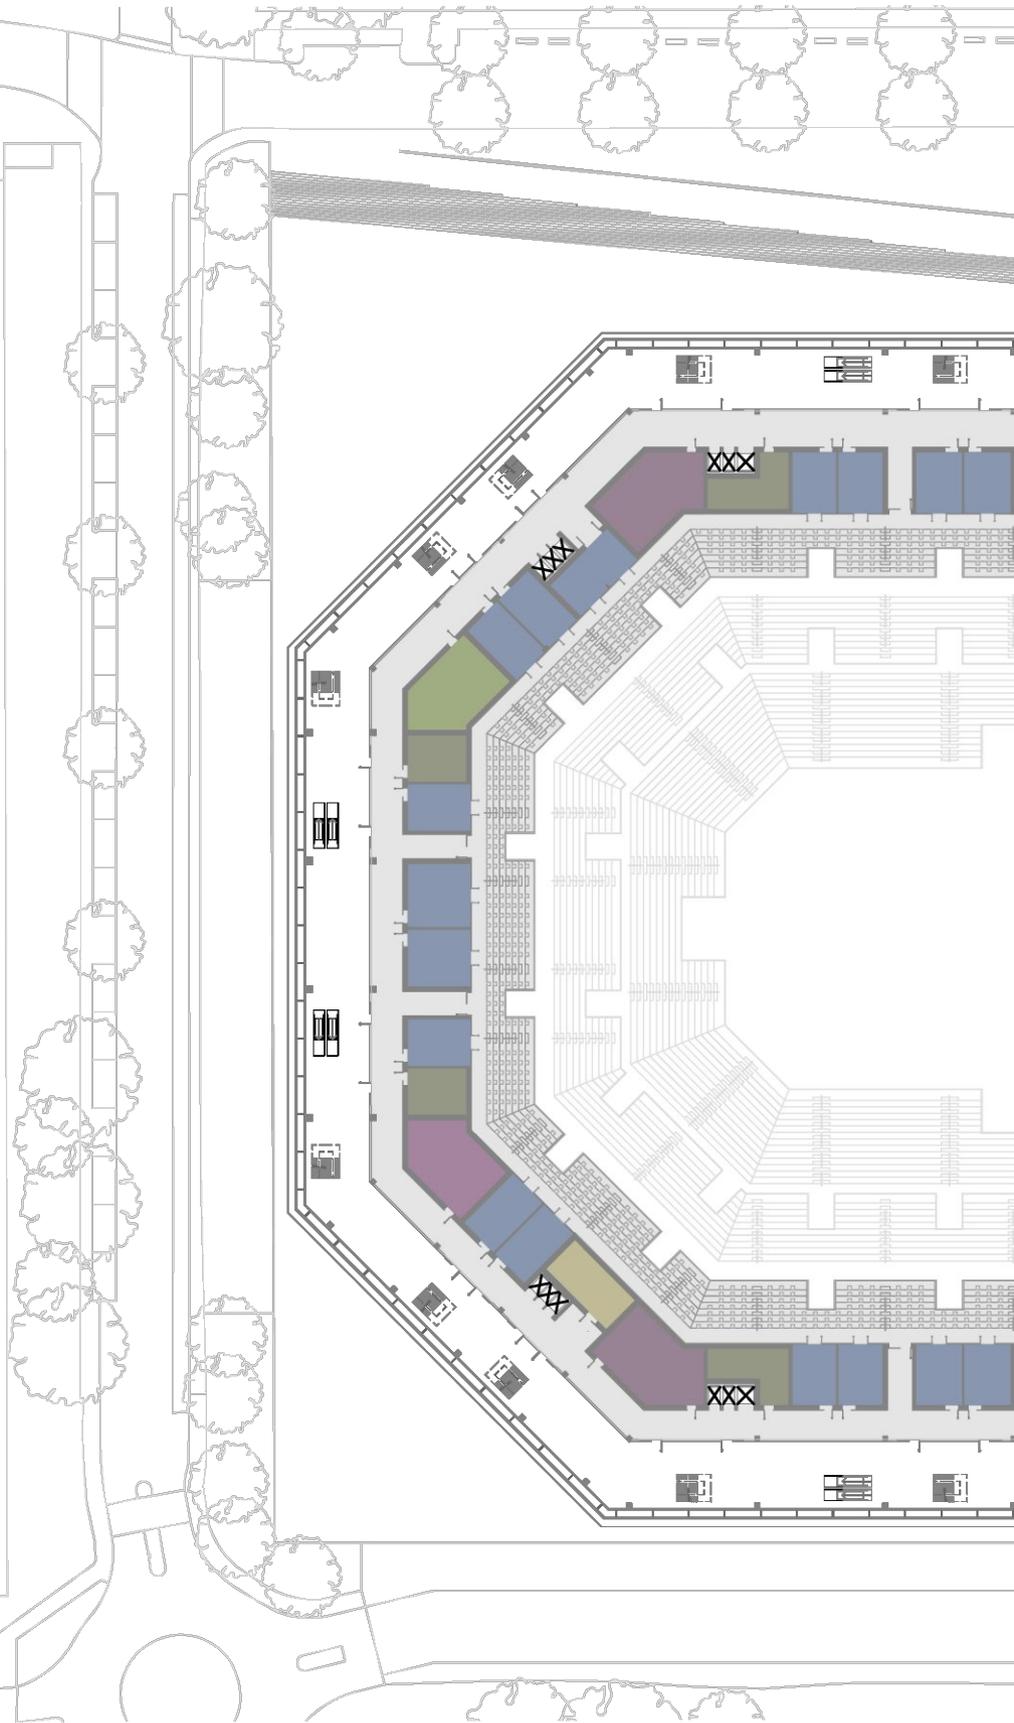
Grundriss 3. OG Nutzungsverteilung
